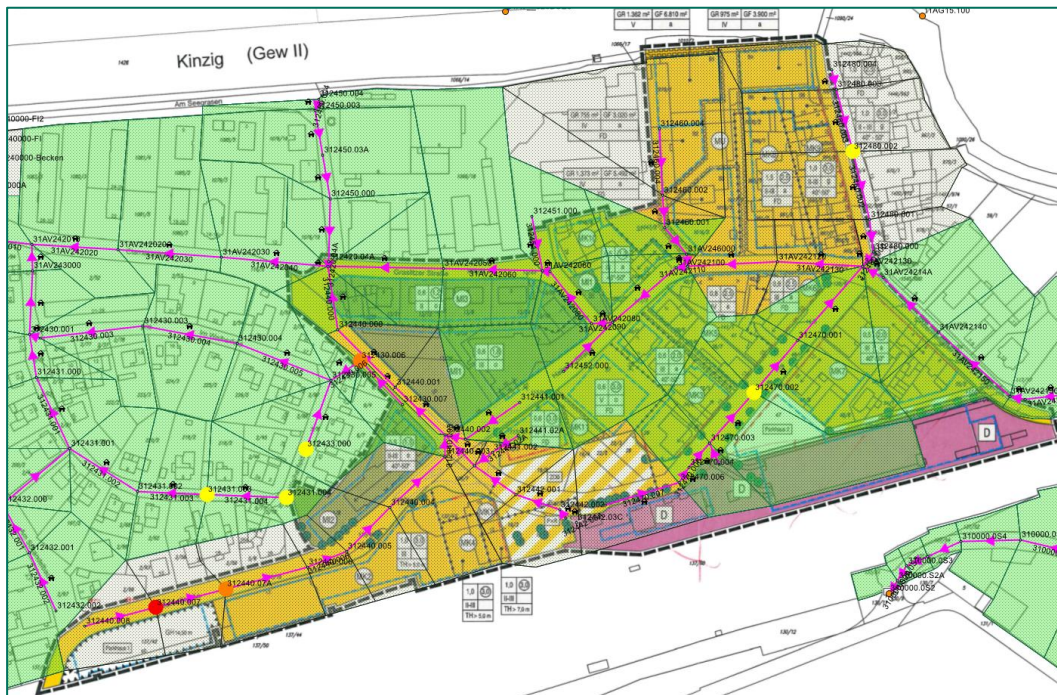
Schächte mit Überstau, bei Modellregen T=10 a im Planzustand mit Bebauungsplan Südstadt
